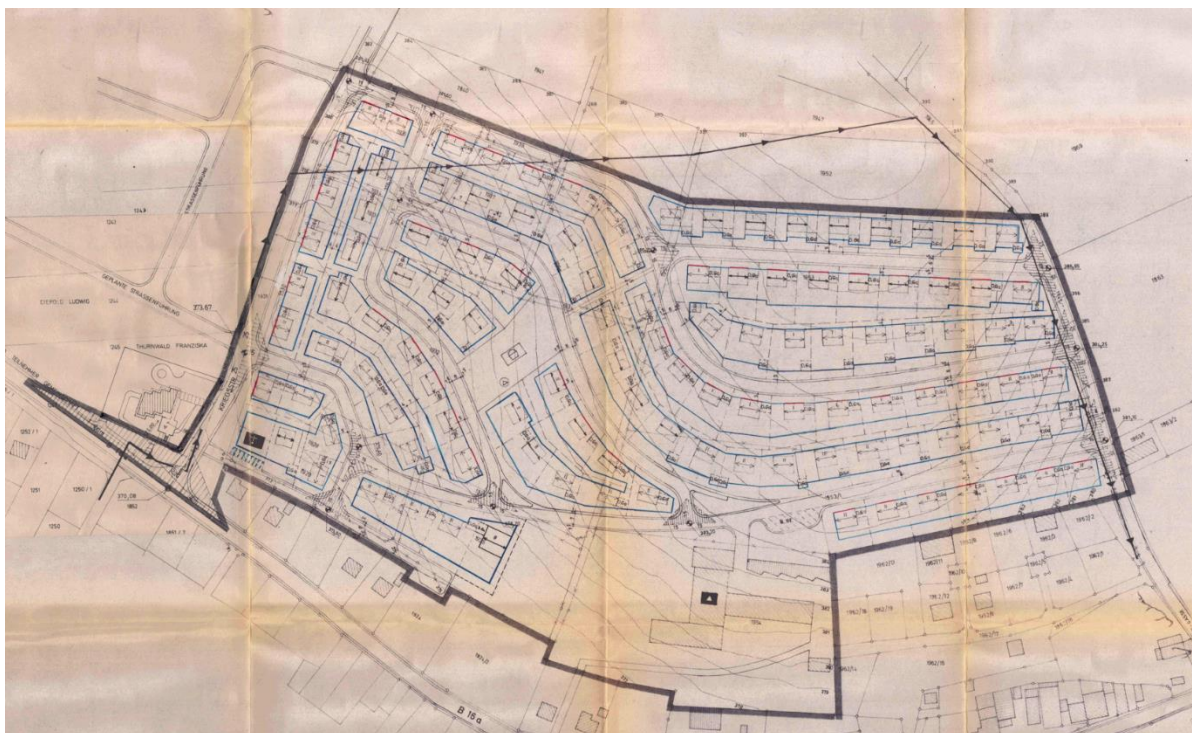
Bebauungsplan „Mehring Berg“ (Stand 1. Änderung 23.06.1976)
